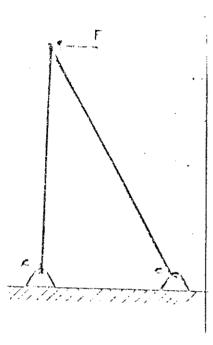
Prova di rigidezza di schema funzionale in pianta (compressione)
